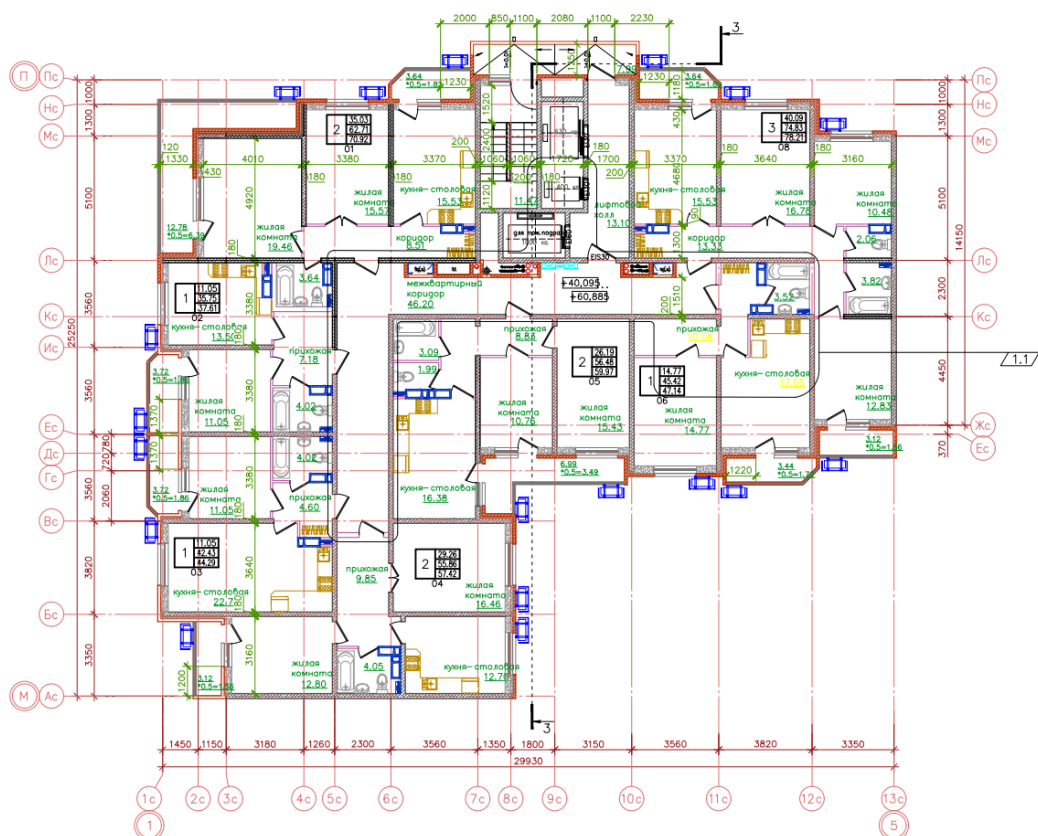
Типовой план 14-21 этажа БС-5 ЖК URAL
